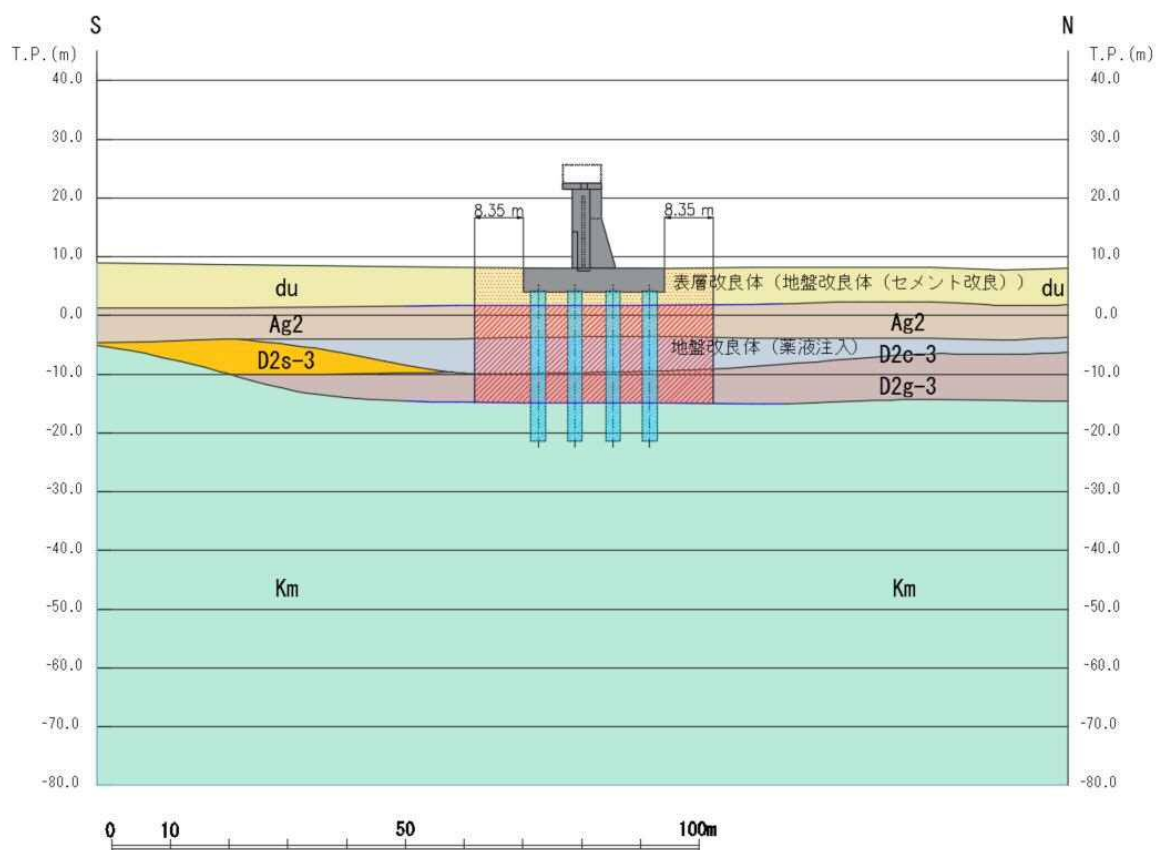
(1) 評価対象断面図 (A-A断面)
